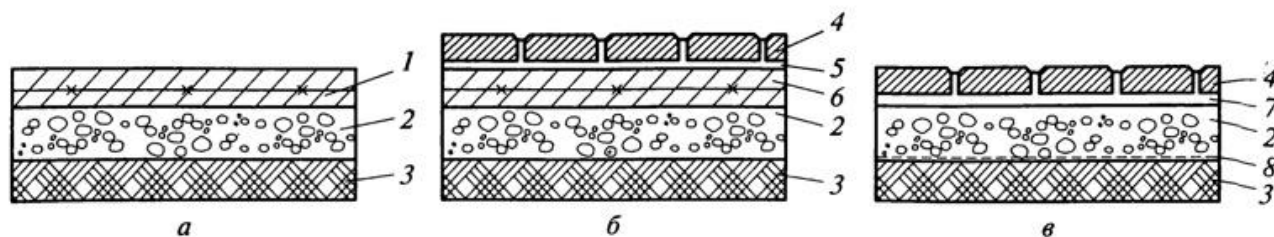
Типовые конструкции твердых покрытий: а - монолитное; б - мощение на жестком основании; в - мощение на упругом основании; 1 - бетонное покрытие, армированное сеткой (толщина слоя - 100 мм); 2 - щебень (толщина слоя зависит от типа грунта); 3 - подготовленное грунтовое основание; 4 - мощение; 5 - цементно-песчаный раствор (толщина слоя - 30 мм); 6 - бетонное основание, армированное сеткой (толщина слоя - 100... 120 мм); 7- каменные высевки (фракция 5 мм) или песок (толщина слоя - 25 мм); 8 - геоткань
